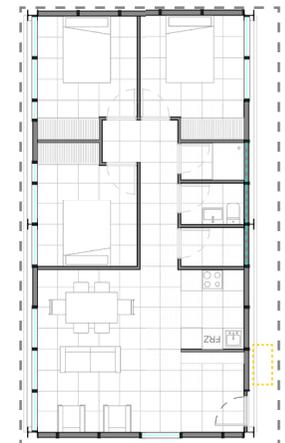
Plantas de ubicación de residuos en tipologías E
